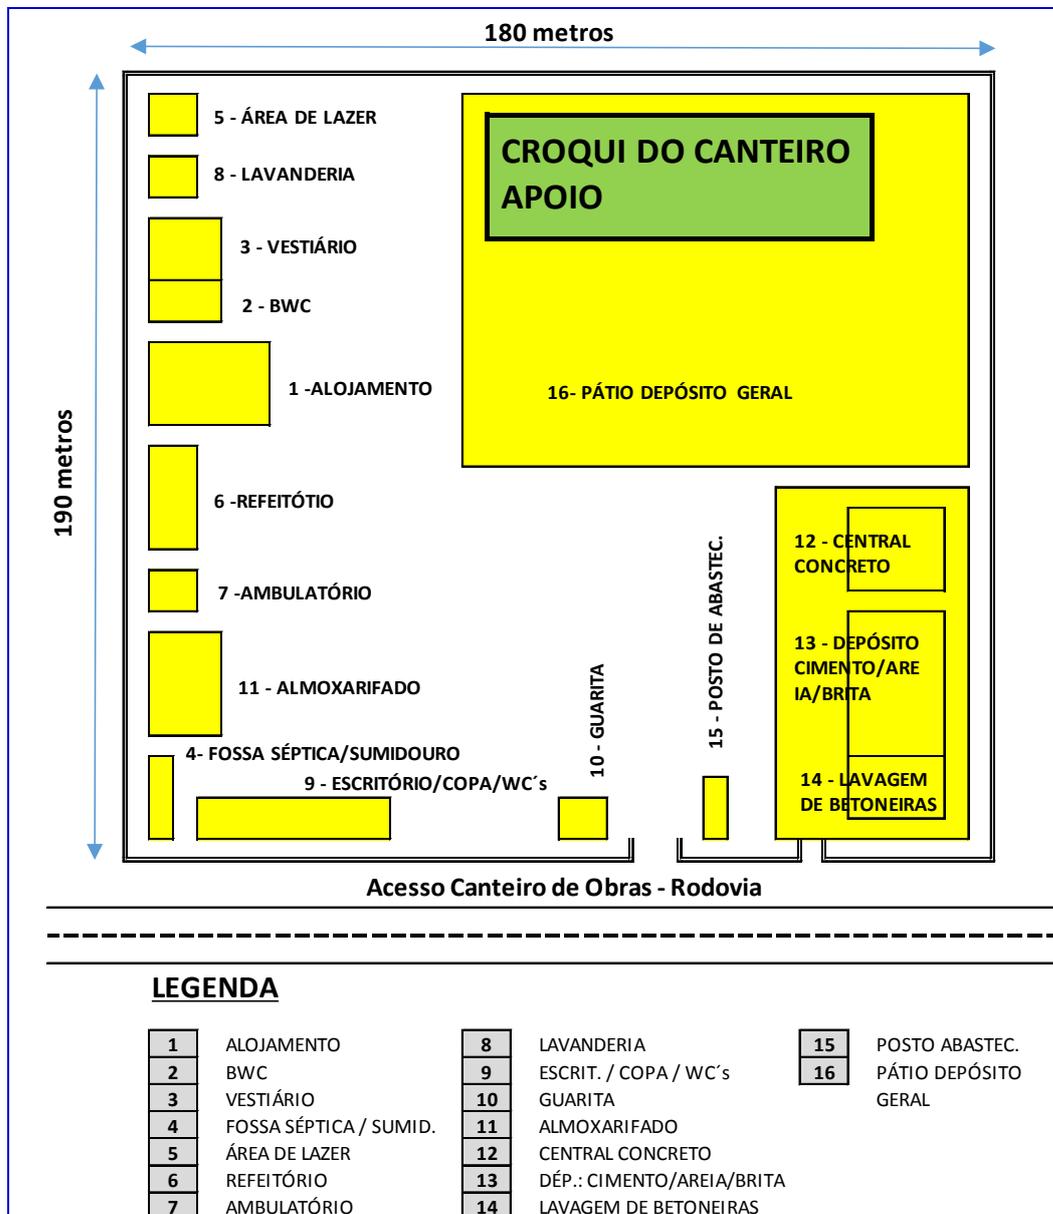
Esquema Ilustrativo das estruturas do canteiro típico (principal e apoio) de obras de LT.
